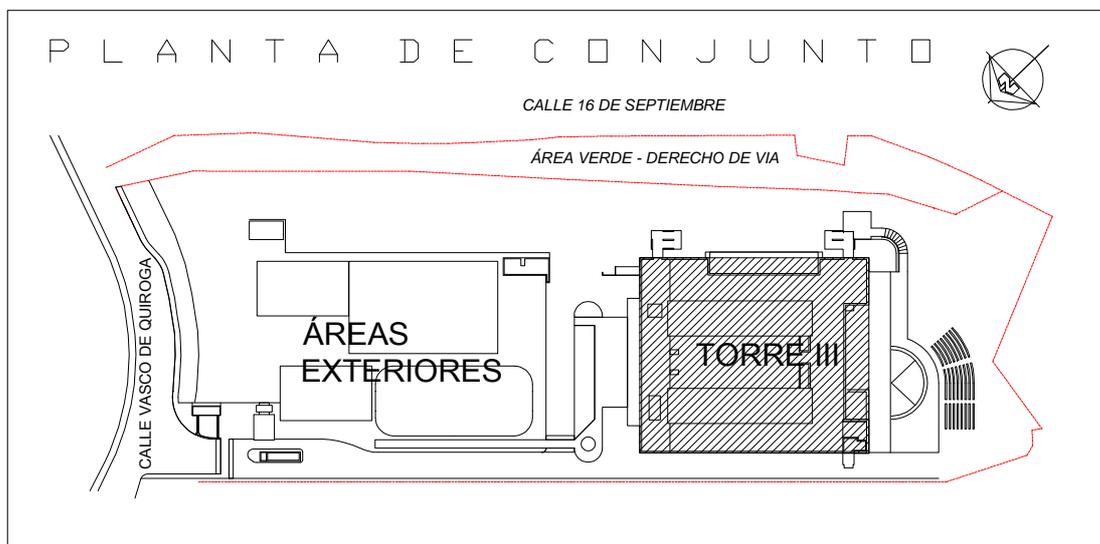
Planta de conjunto en etapa I (Elaboración propia).
